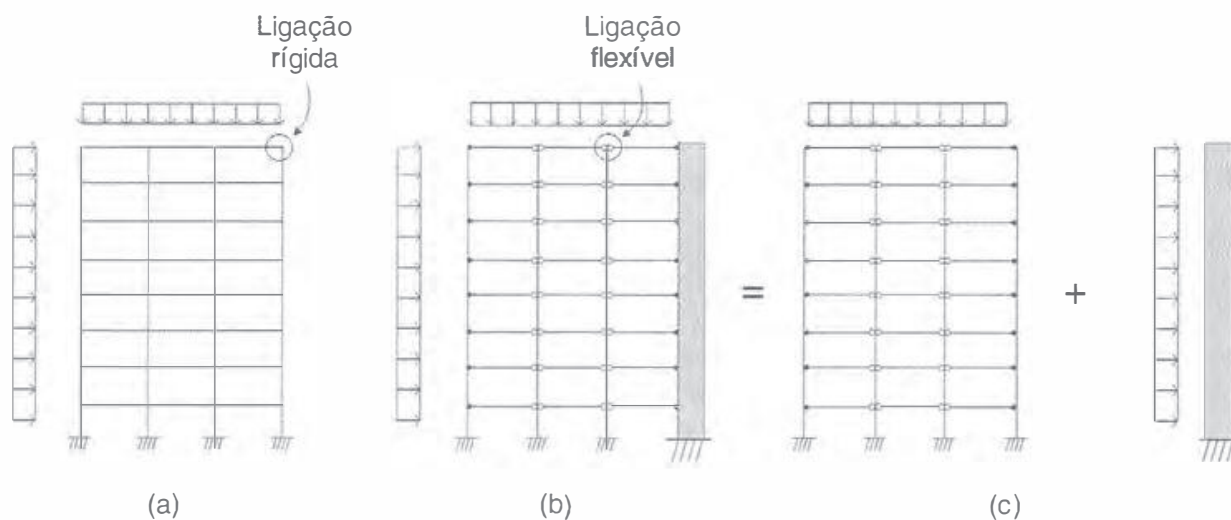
Tipos de estruturas de edifícios: (a) pórtico (com ligações rígidas entre vigas e pilares); (b) estrutura com ligações viga-pilar flexíveis, a qual deve estar associada a uma subestrutura de contraventamento para fornecer rigidez lateral e resistir às ações horizontais; (c) decomposição dos sistemas componentes da estrutura da figura b com subestrutura de contraventamento do tipo parede-diafragma.
